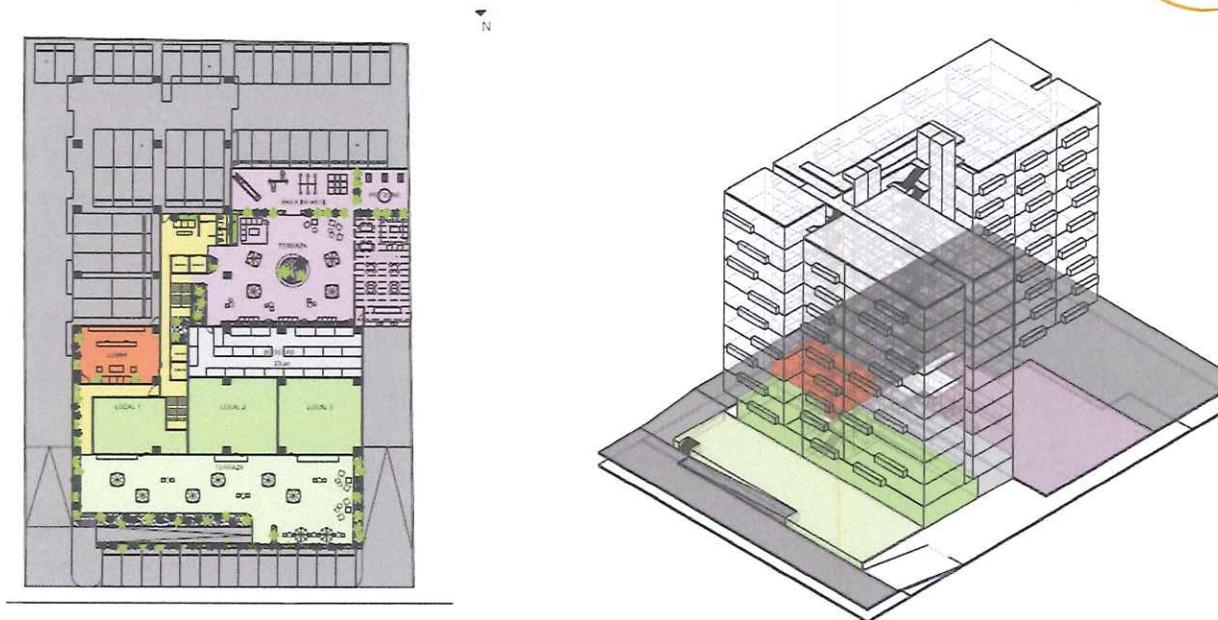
Planta de conjunto. Fuente: Plano Arquitectónico.
